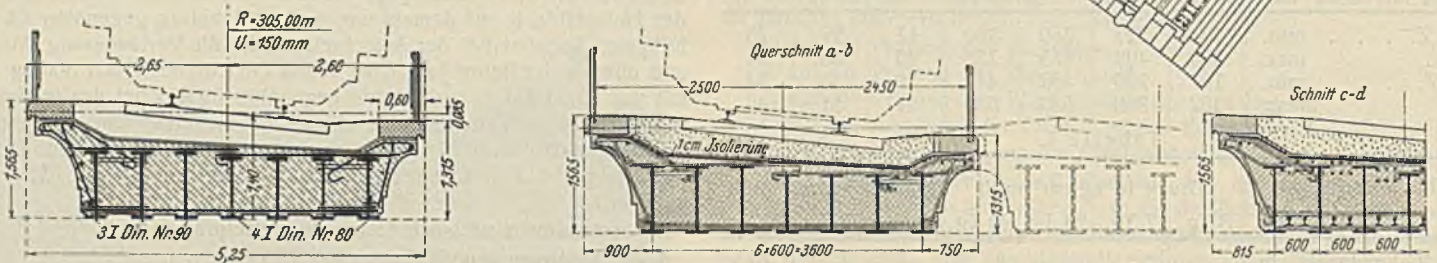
Querschnitte durch die Trägerdecken mit Bewehrungen.
